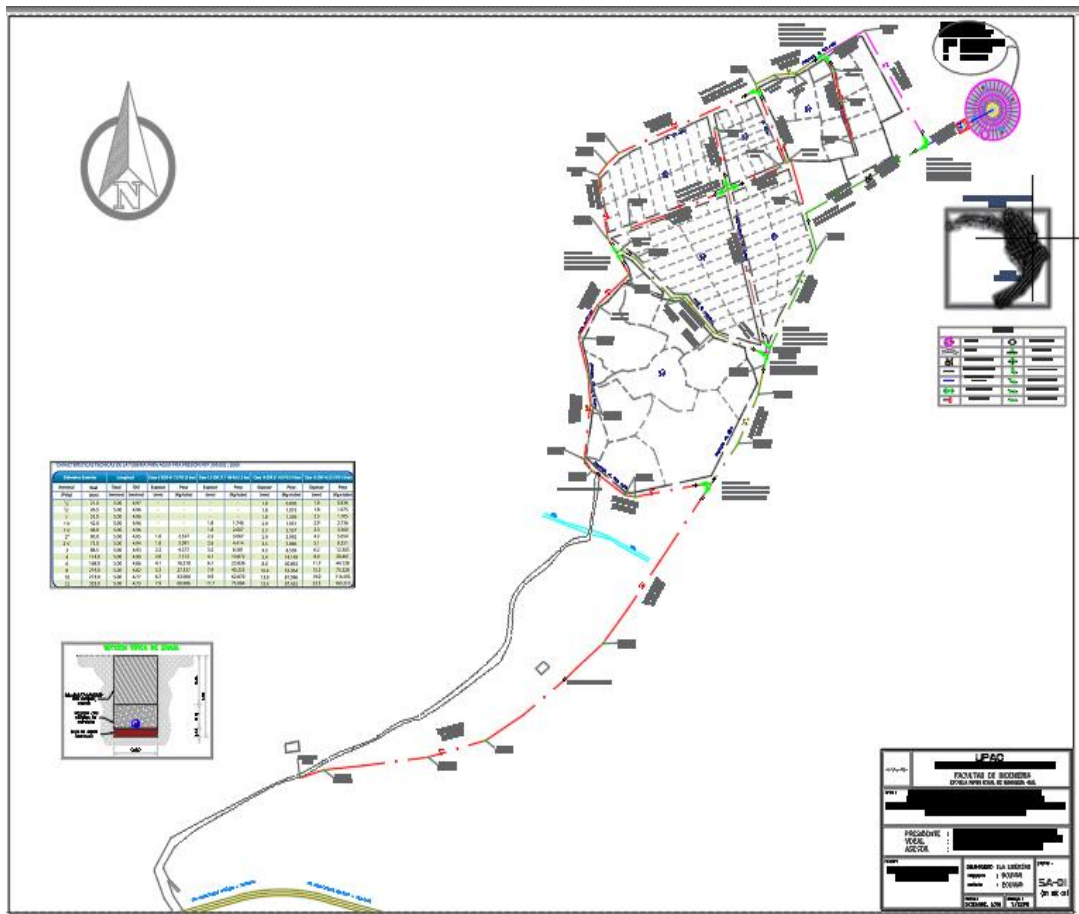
Plano en planta de la distribución de la red de agua potable. Fuente: Planos Autocad.
